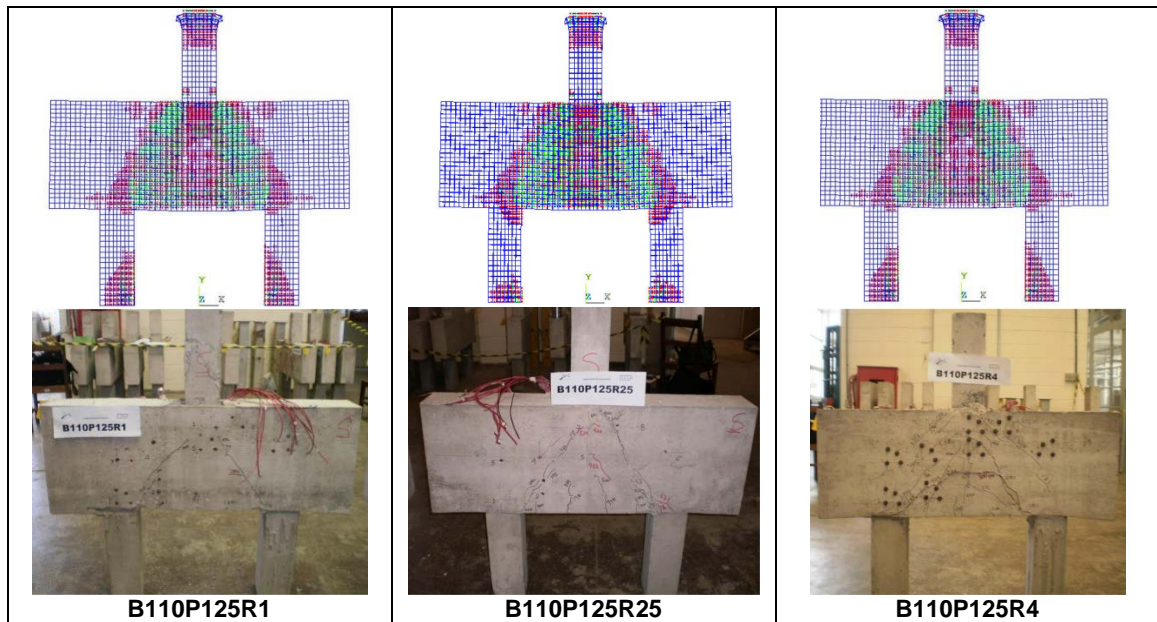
Configuração final de fissuras dos modelos da série B110
